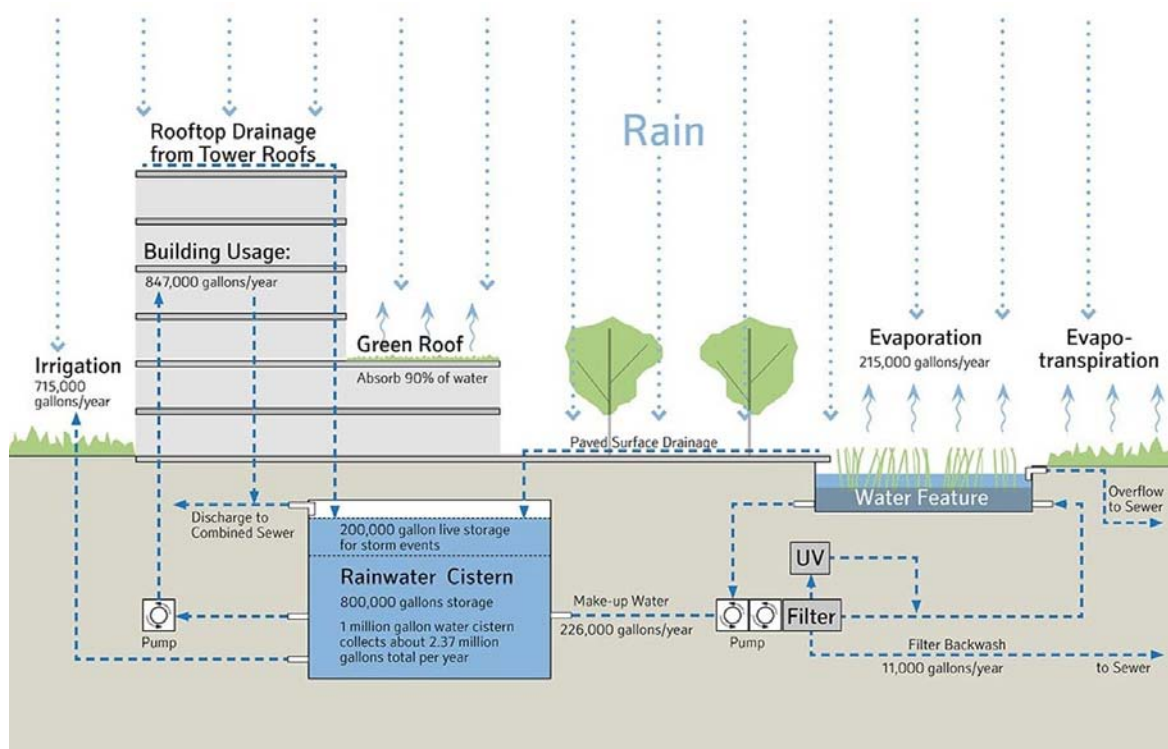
Bill & Melinda Gates Foundation - Schema di recupero dell'acqua - Roof garden.
